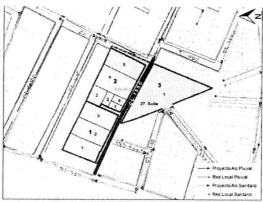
Redes alcantarillado sanitario existentes. Fuente: SIGUE EAAB
